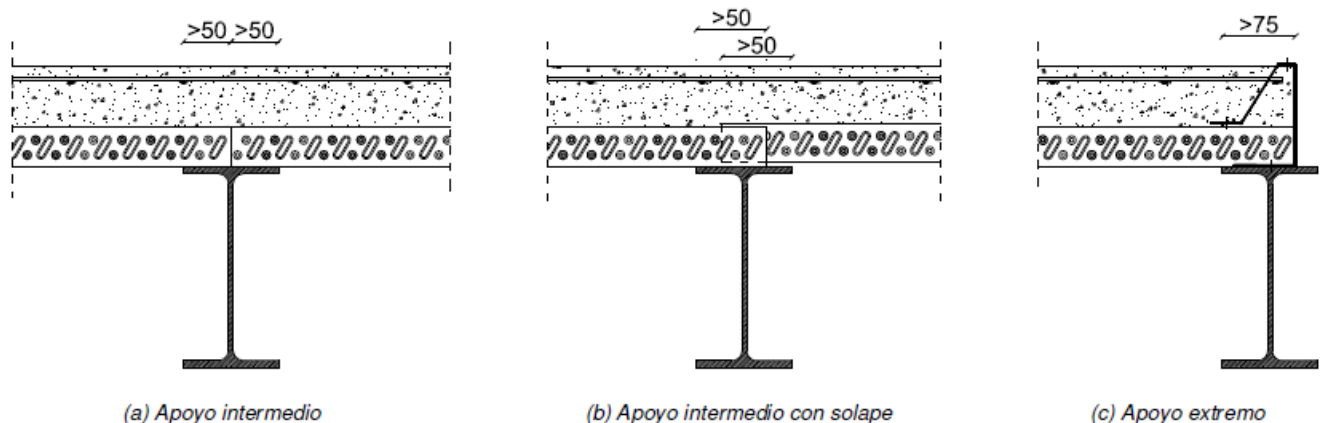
Apoyo sobre estructuras metálicas (tomada de [9])
